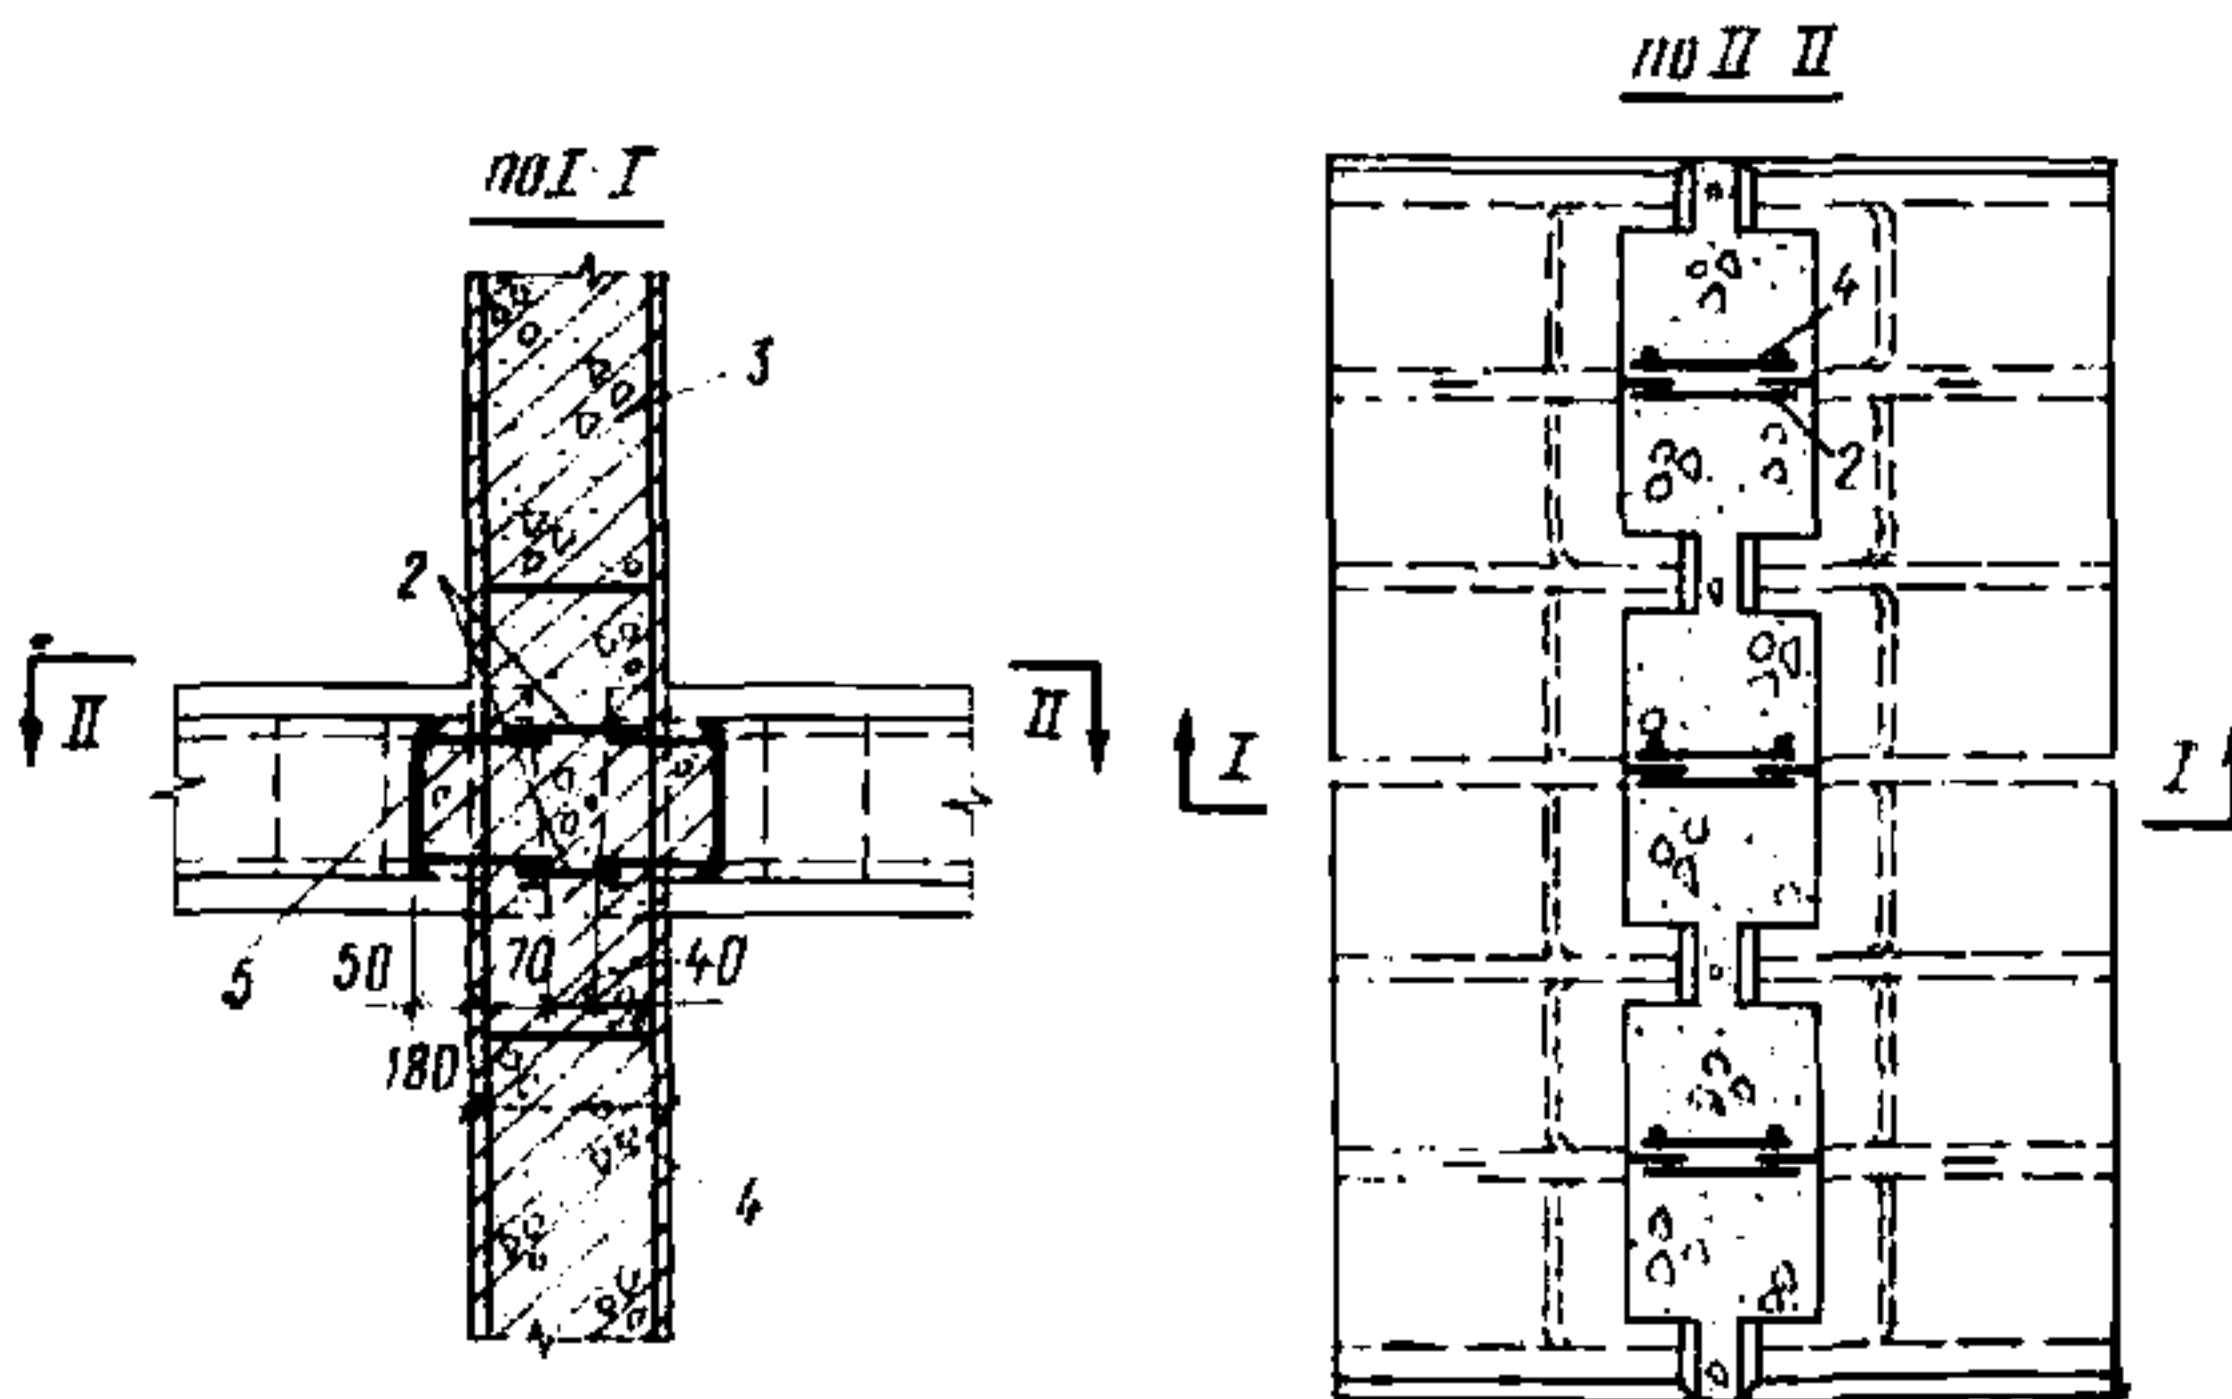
Конструкция стыка с прерывистым опиранием на монолитные стены многопустотных плит
